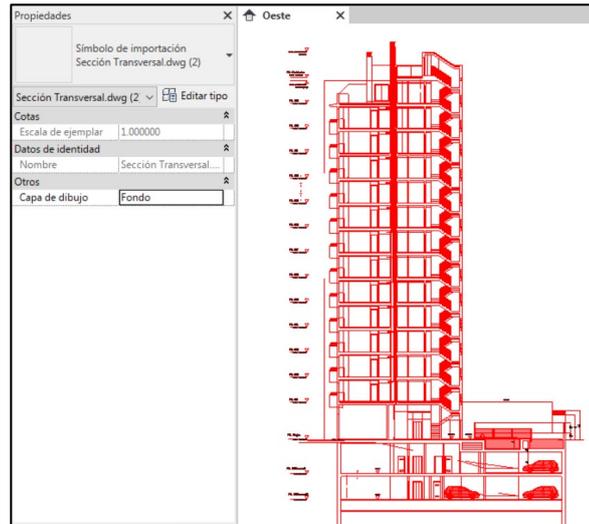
Dibujo de Sección transversal de Proyecto importado en Vista de alzado Oeste de Revit.
